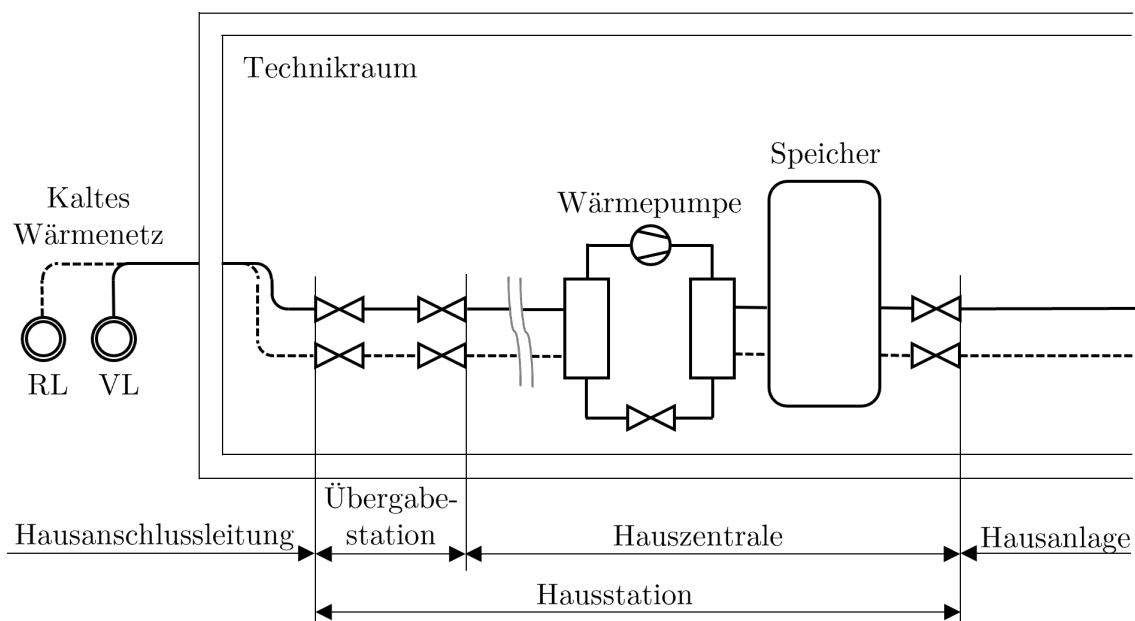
Haustechnik mit Hausanschluss und Hauszentrale eines Wärme- und Kältenetzes der fünften Generation mit der Übergabestation vor der Wärmepumpe
